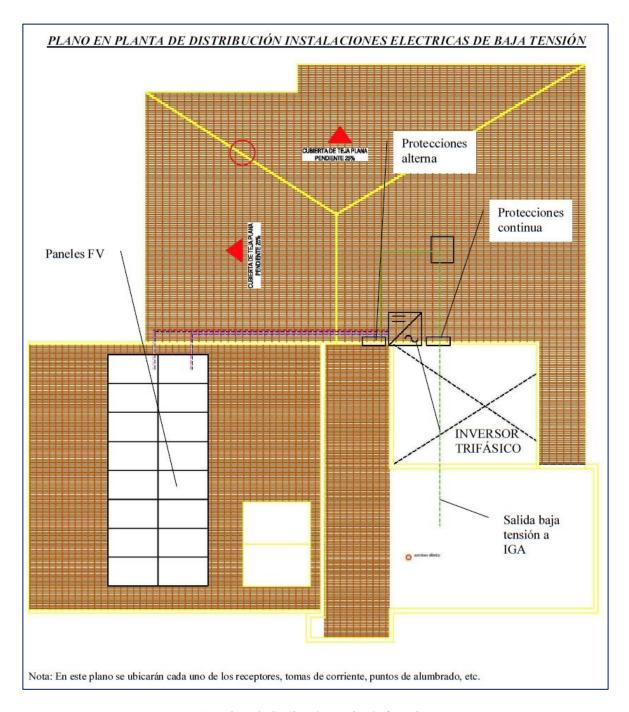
Plano de distribución instalación fotovoltaica
